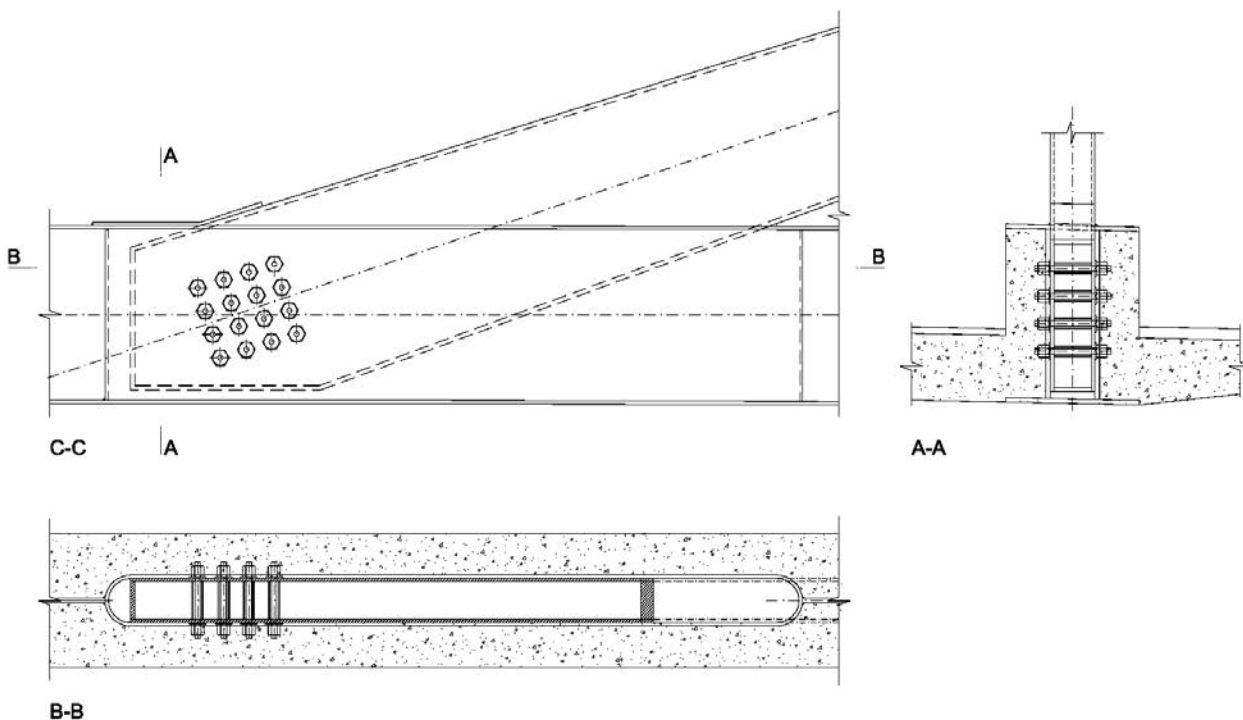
Unión del tirante rígido con la viga longitudinal del tablero
